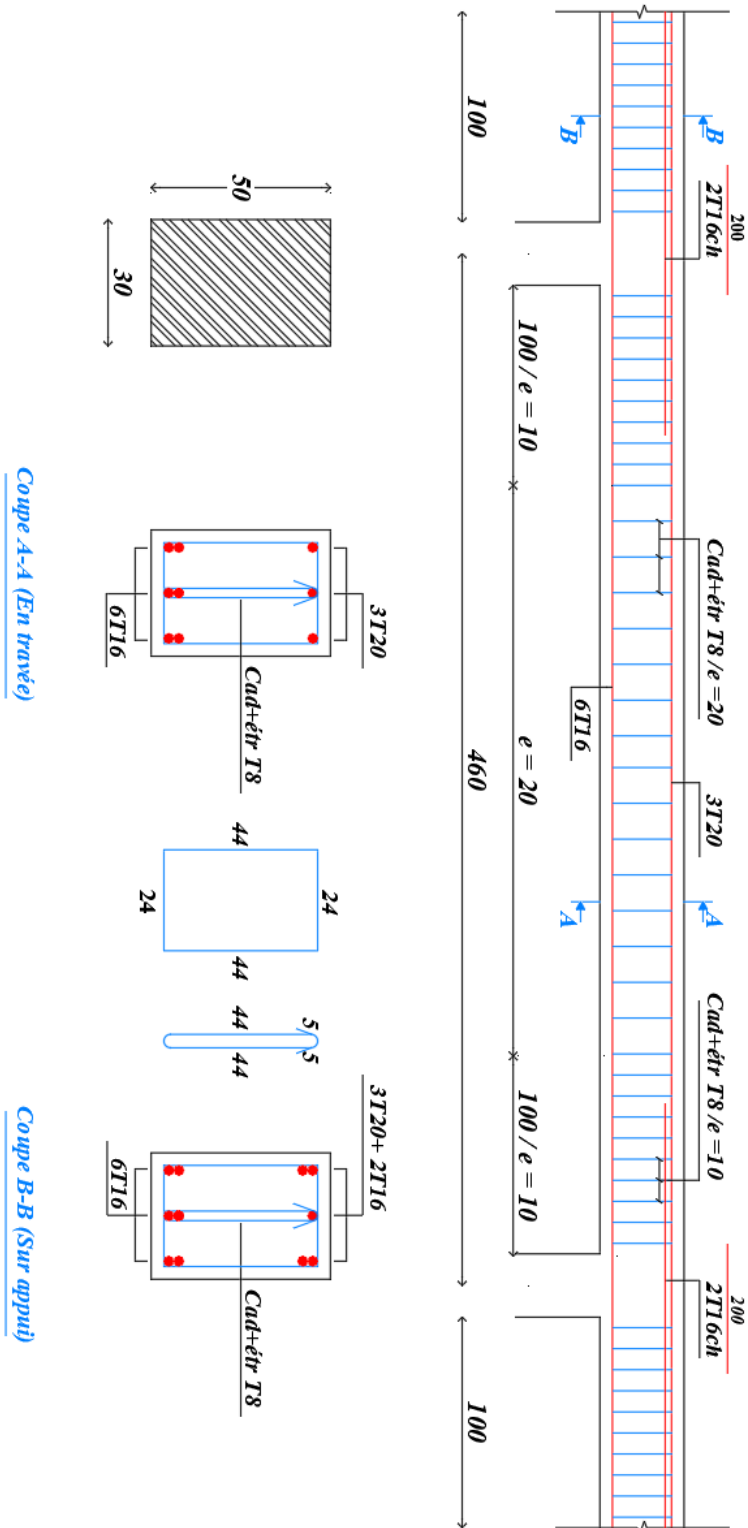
Schéma de ferrailage des poutres principales Axe :3
